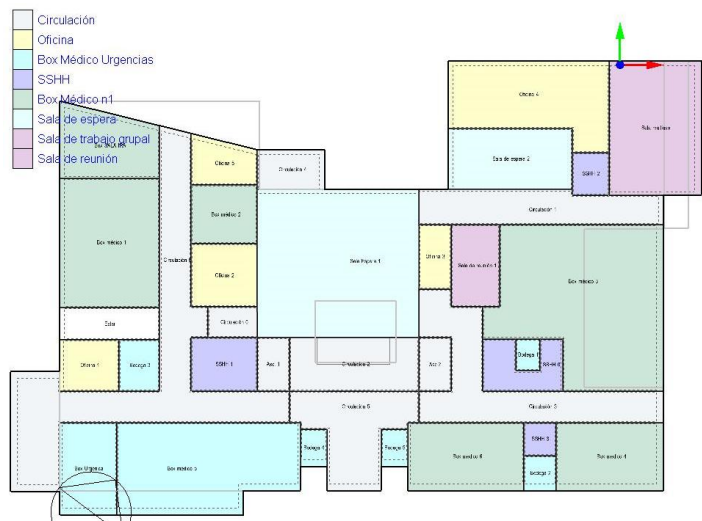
Planta Nivel 1 - Zonas Térmicas
